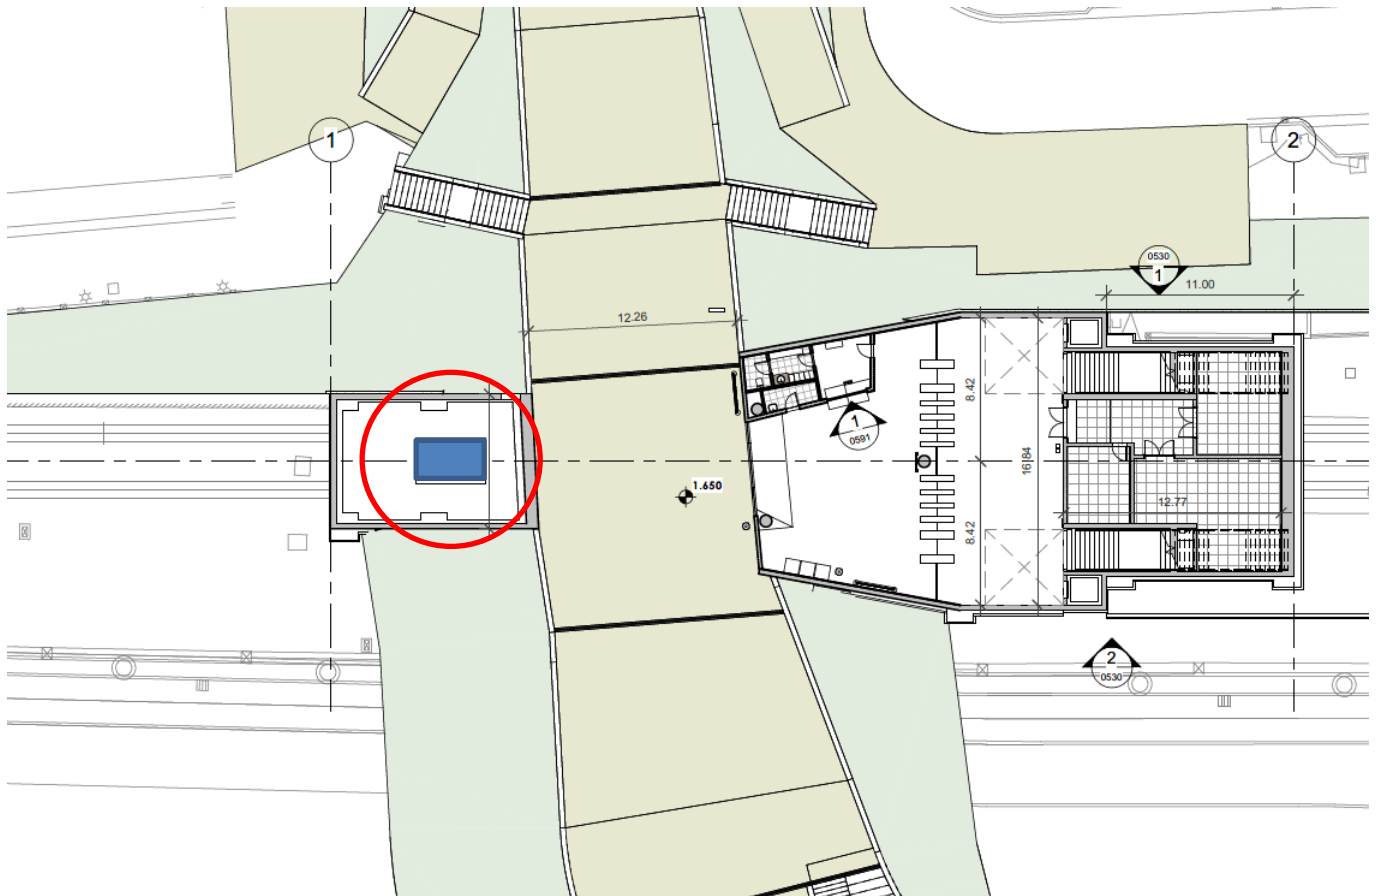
Ubicación prevista para el pozo de bombeo en el interior del estribo oeste
